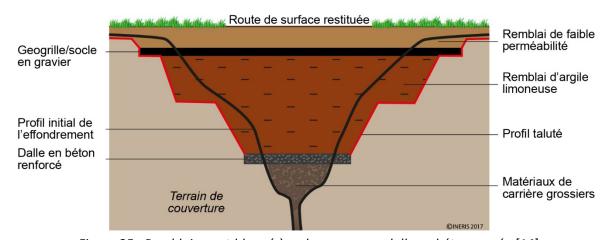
Remblaiement bloqué à sa base par une dalle en béton armée [14]
